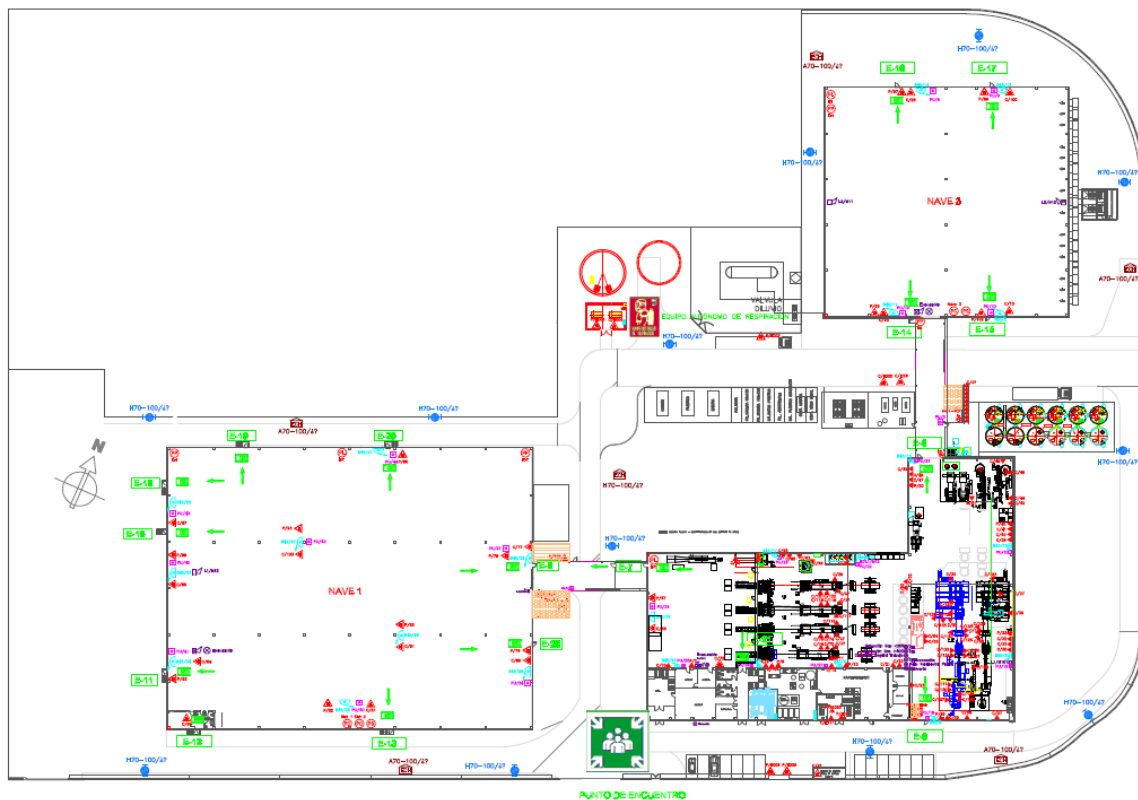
Plano de la planta en el año 2011 (Faerch, 2022)
